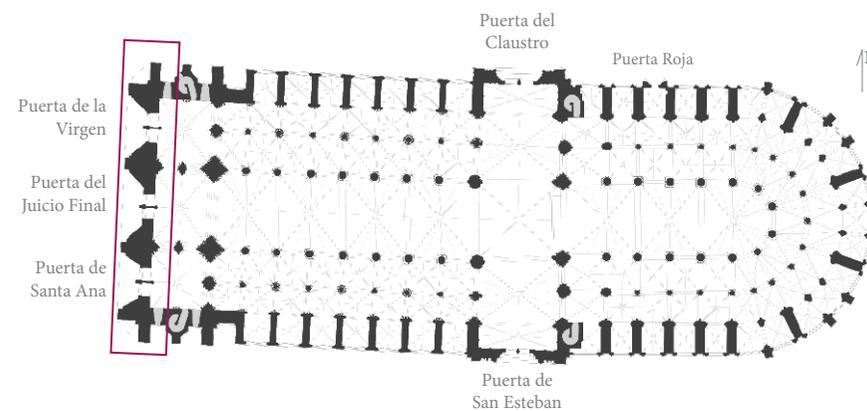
Planta de la catedral de Notre Dame de París (Fuente: Elaboración propia)
